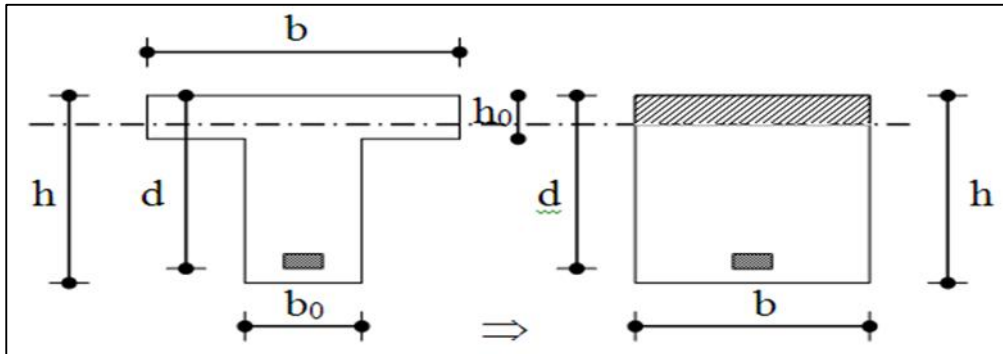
Coupe de Section Rectangulaire et Section en T
